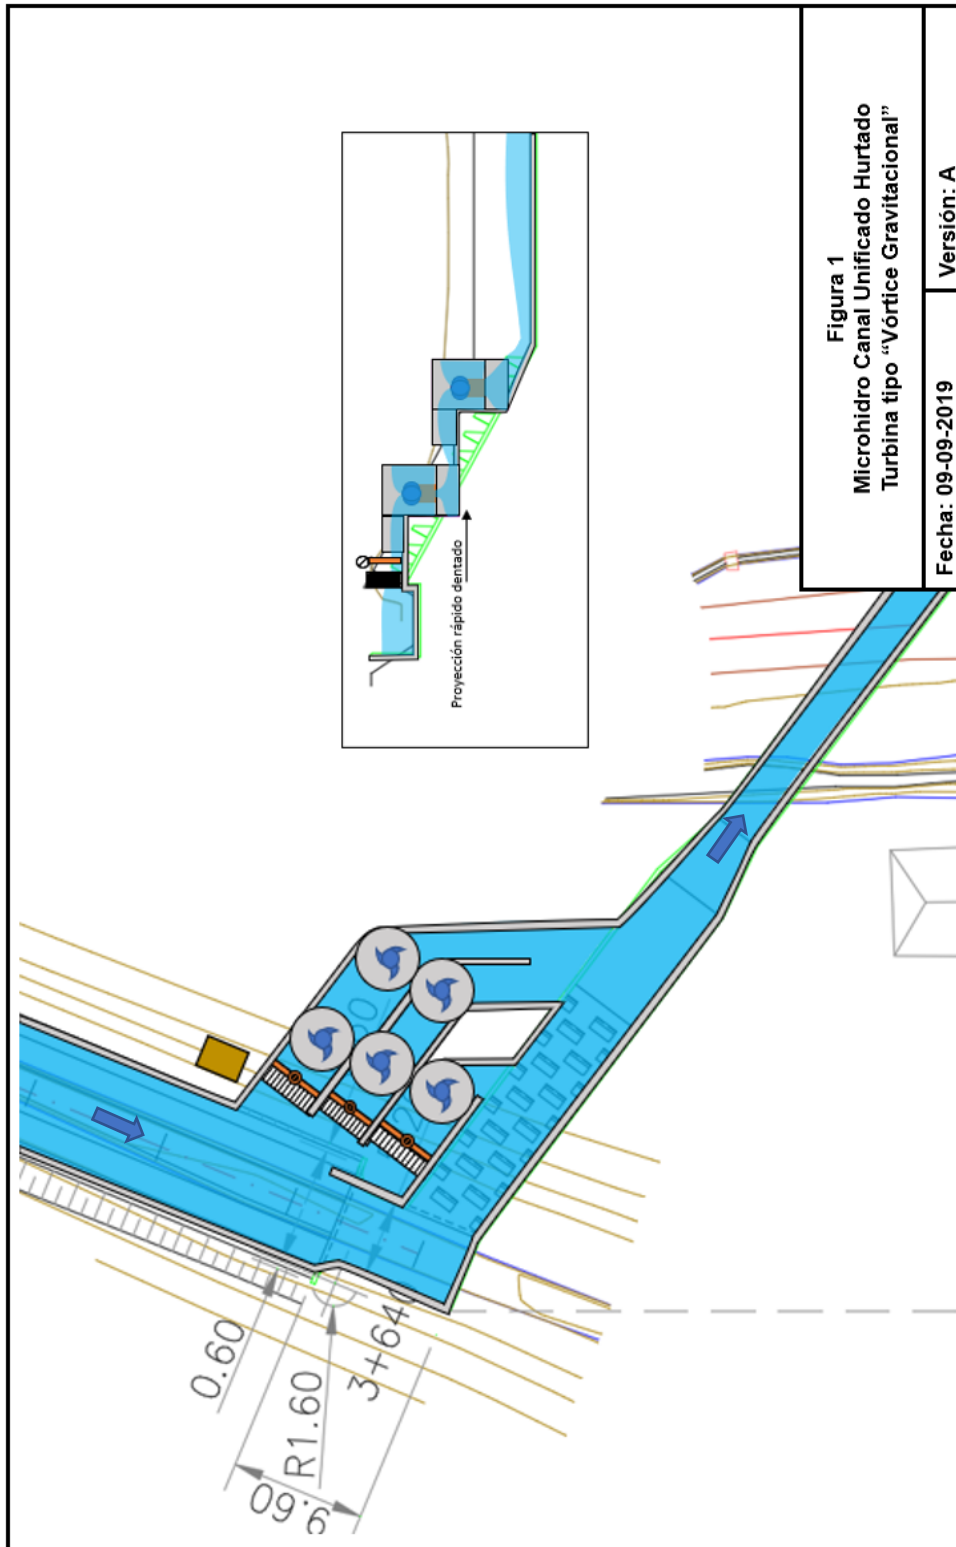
Esquema de implantación de una central de generación tipo "Vórtice"; vista en planta y elevación
